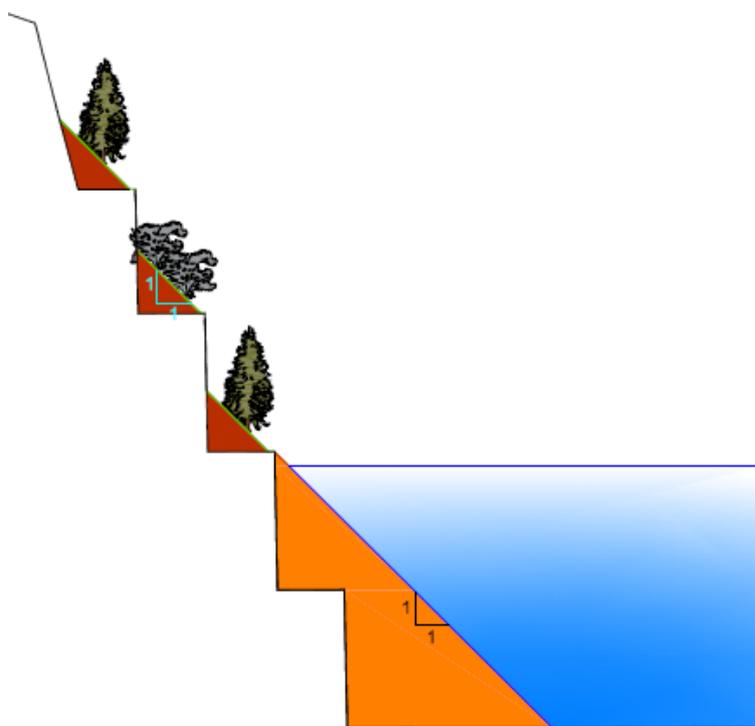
Esquema representativo da solução de enchimento e modelação das bancadas proposto no PARP -Fonte: PLANO_Pedreira_1.zip – Planta 5-A, Pormenor da geometria tipo das bancadas – Perfis situação final de recuperação paisagística
